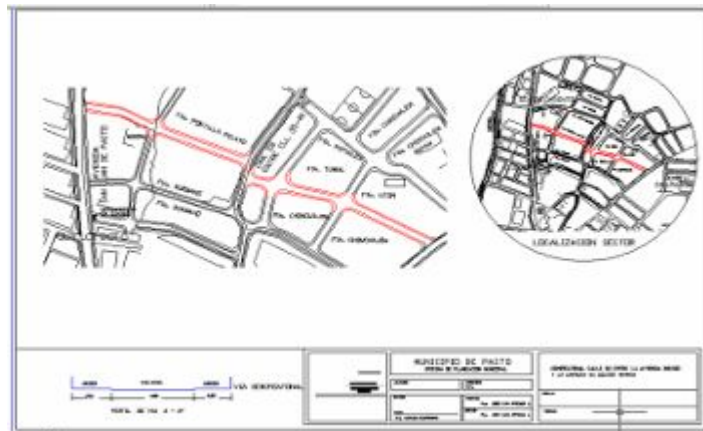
Planta y sección transversal calle 38 entre Avenida Inesco y carrera 26
